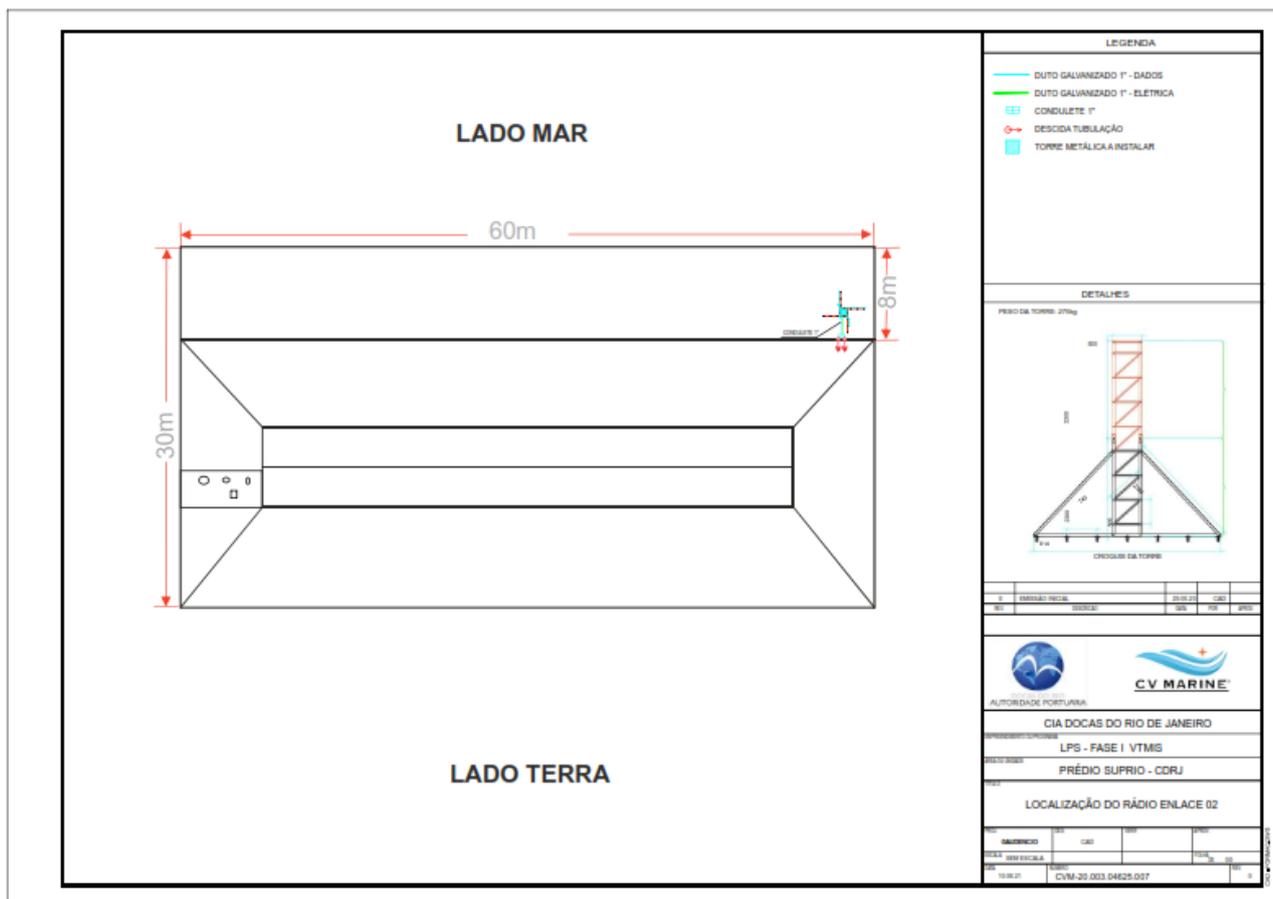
Planta de localização do Radio Enlace 02 - SUPRIO.
